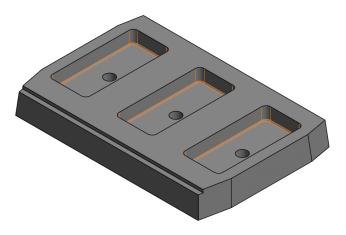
Dalle préfabriquée pour rehaussement constant (5)
